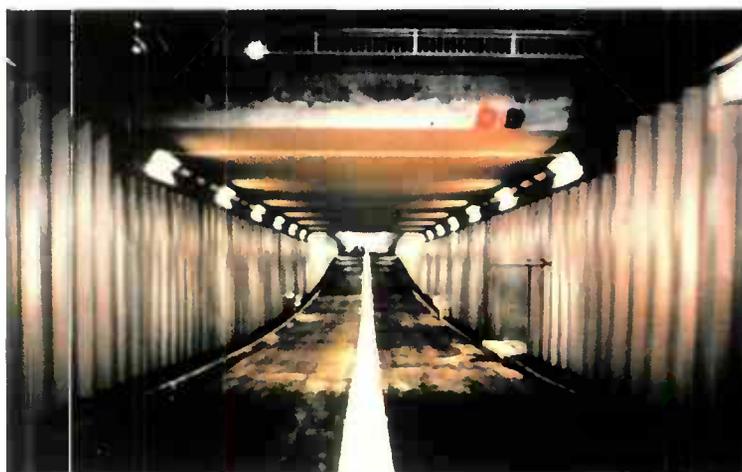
Passage souterrain dont les poutres sont constituées de rideaux de palplanches métalliques
